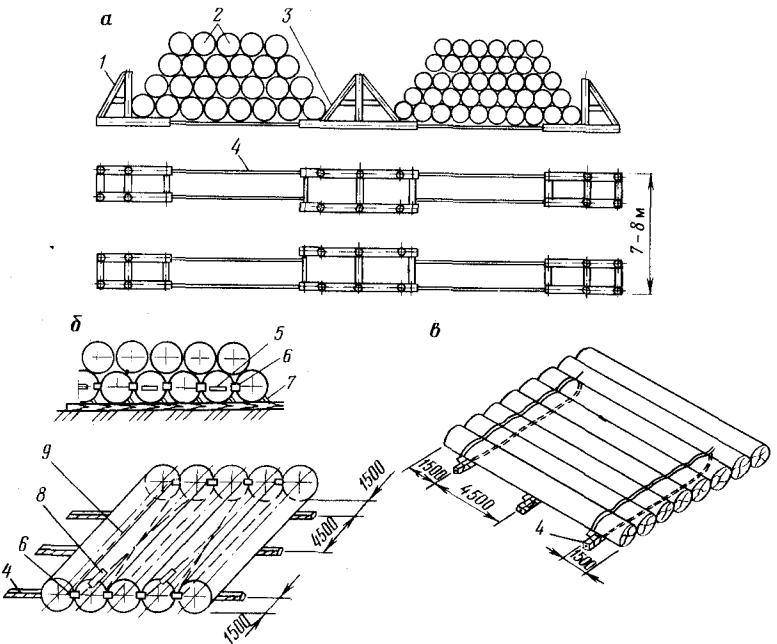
Схемы штабеля труб разных диаметров с использованием опорных разделительных стоек (а), внутренней (б) и наружной (в) увязки труб:
